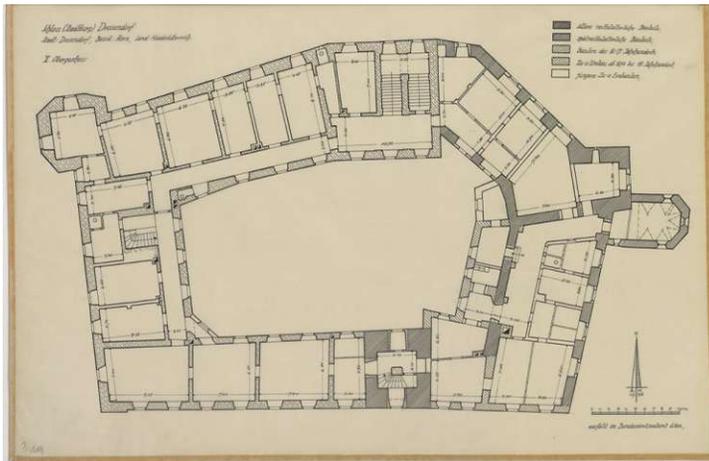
Grundriss EG mit Bauphasen (1955)
